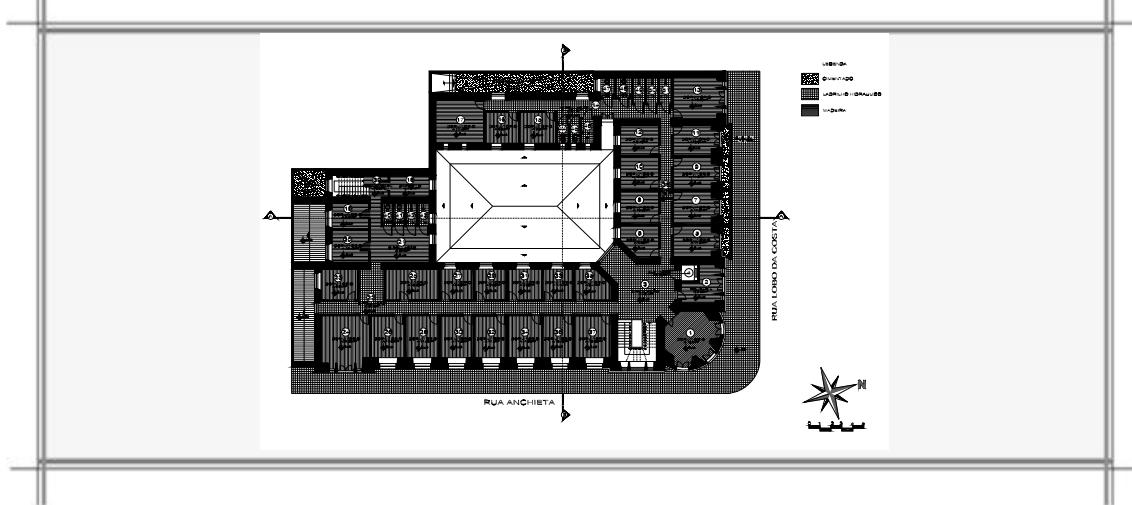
Planta Baixa do 3º Pavimento. Desenho: Cristiane Müller.
